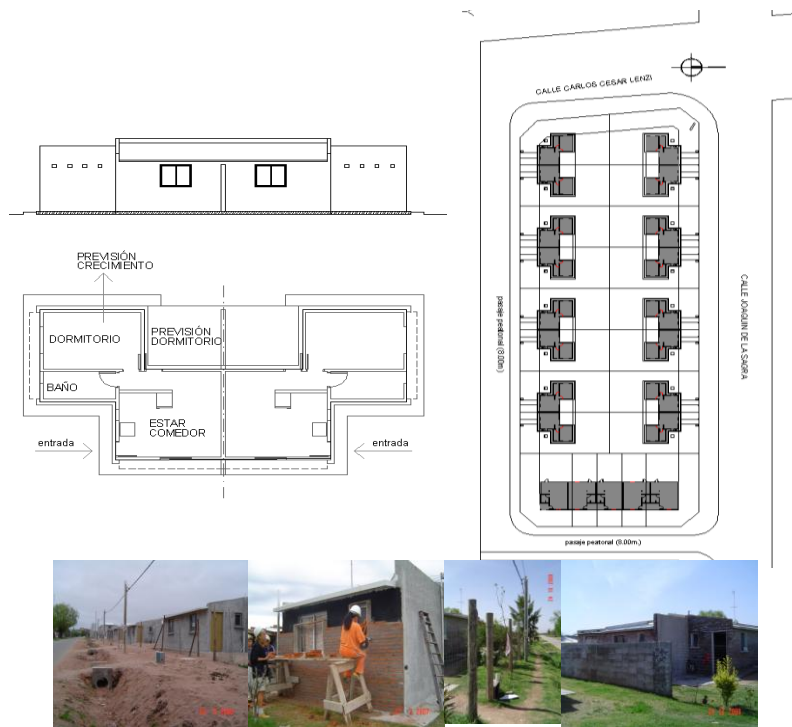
Complejo habitacional sobre calle Joaquín de la Sagra: planta de ubicación, planta y alzado de la casa suministrados por el Servicio de Tierras y Viviendas de la IMM en el año 2006. Fotos del mismo barrio, de la autora, año 2006- 2007.
